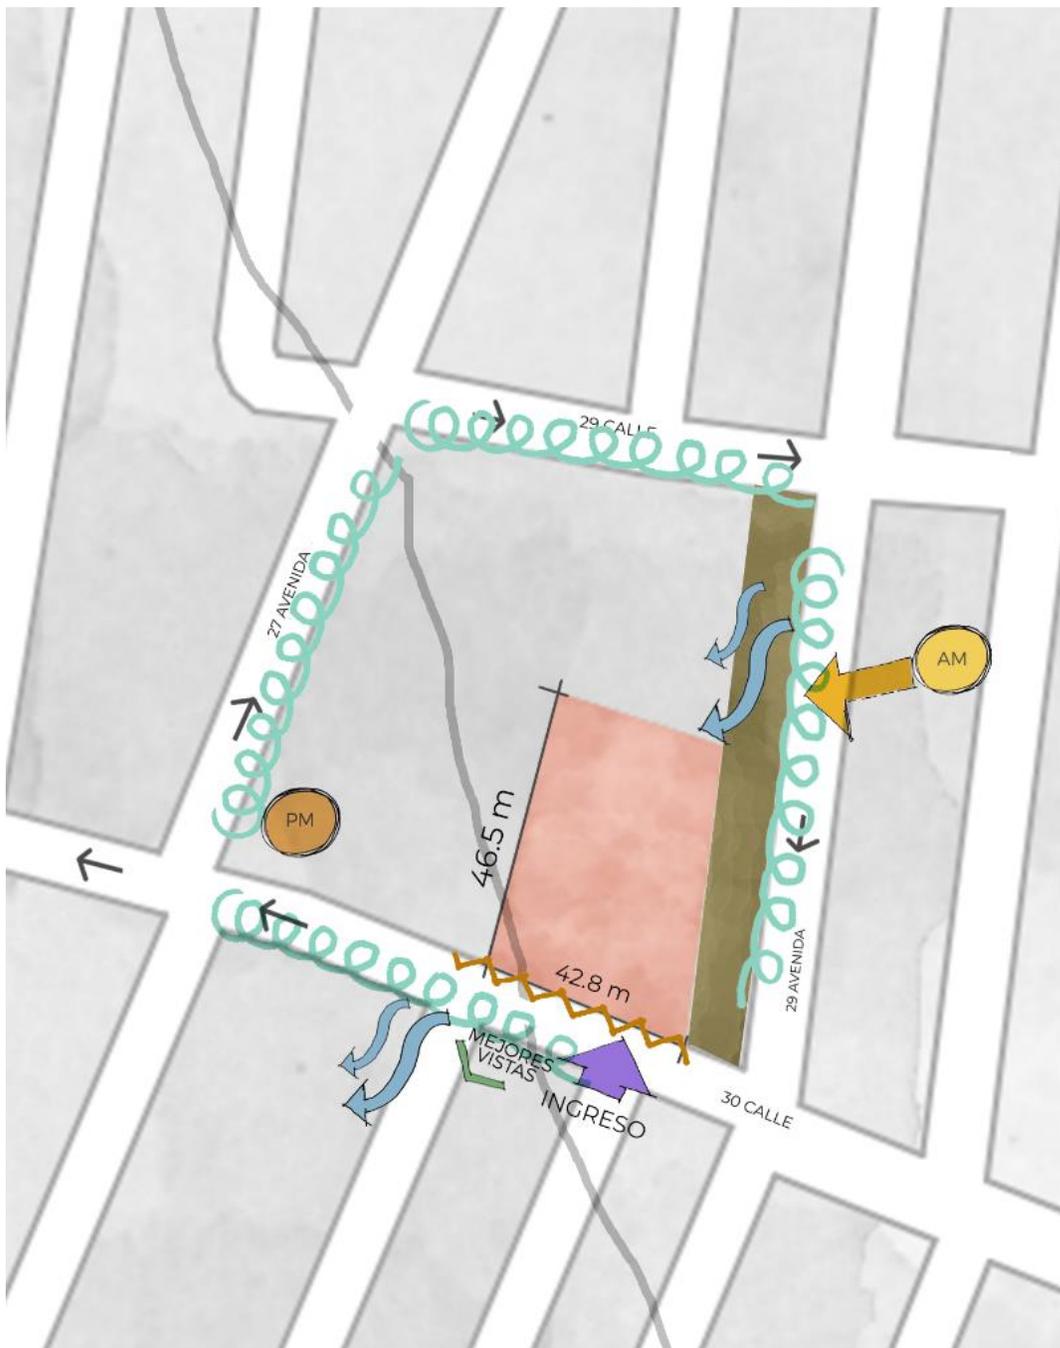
"Análisis de Sitio: Planta resumen". Elaboración propia.
